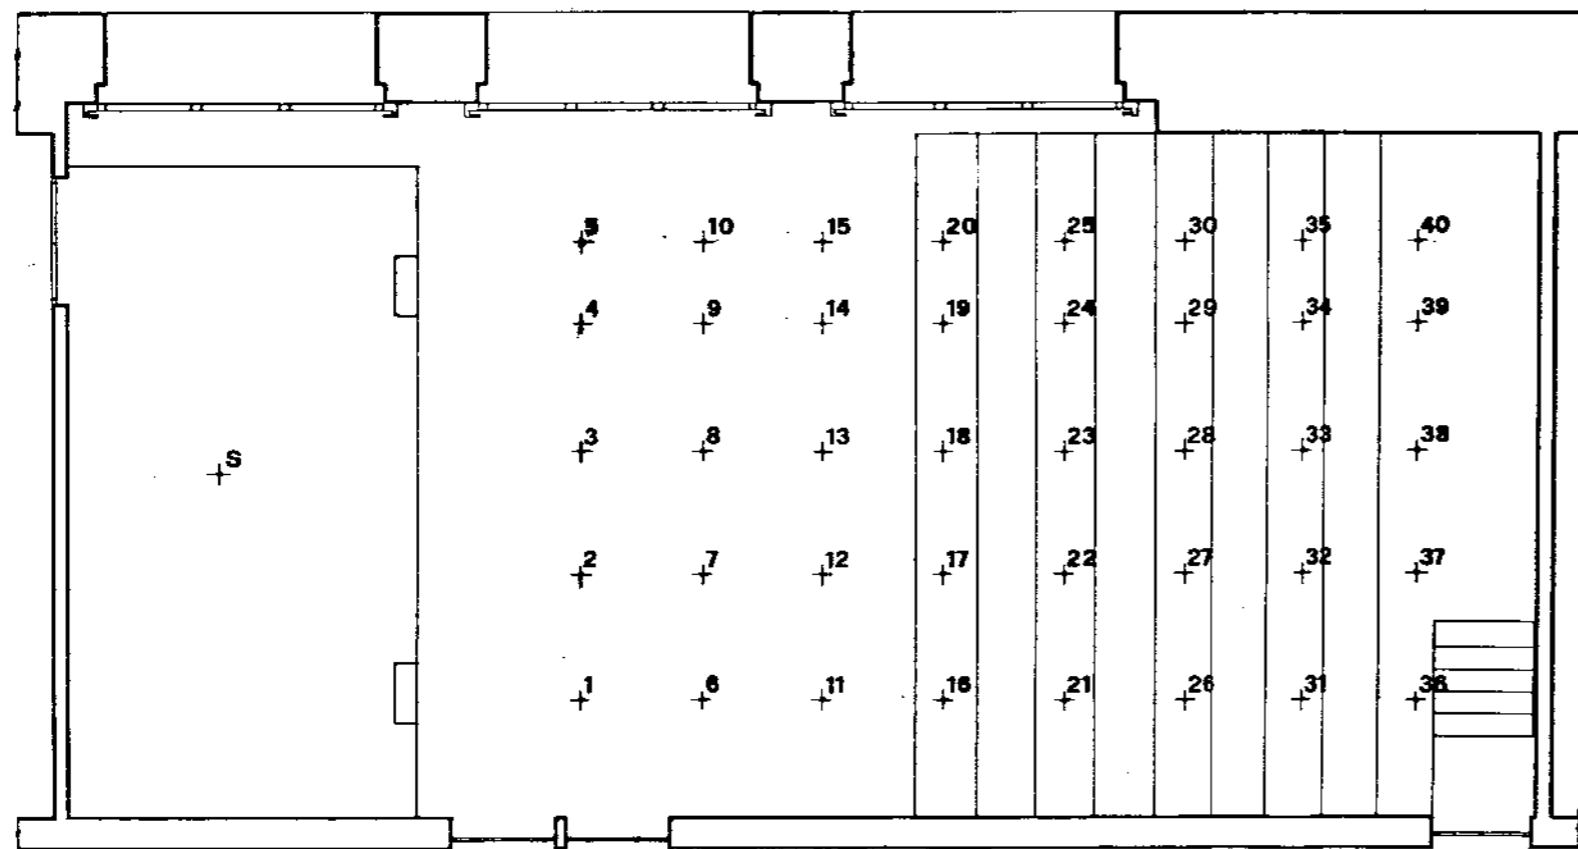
Pianta e sezioni dell' Aula Magna (Aula 2.1).
